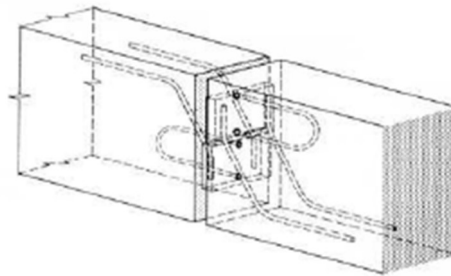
Ligação por chapas metálicas verticais (Stupré, 1981)
